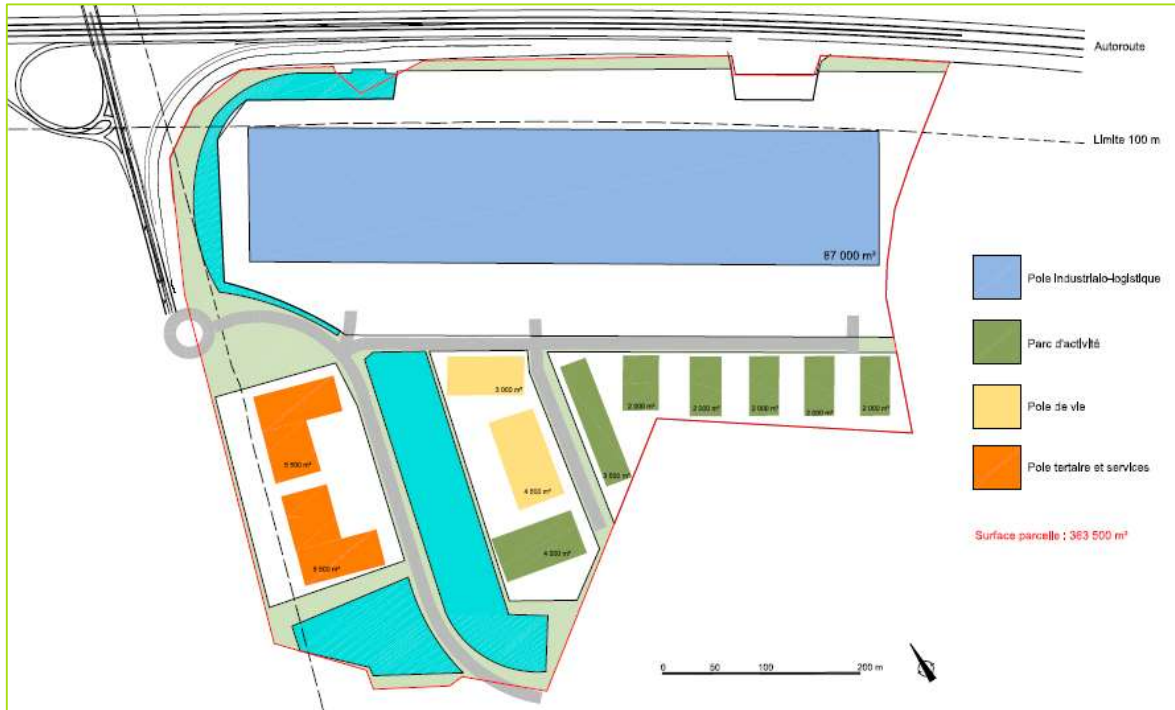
Plan masse du 27 janvier 2022 (Source : Espace Libre/SUEZ Consulting)
